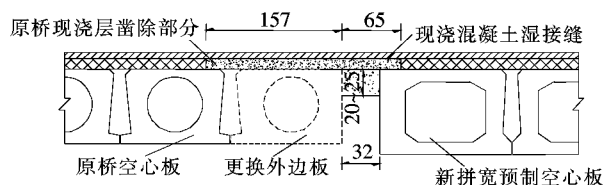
预应力混凝土空心板桥拼接部位细部构造示意(单位:cm)
